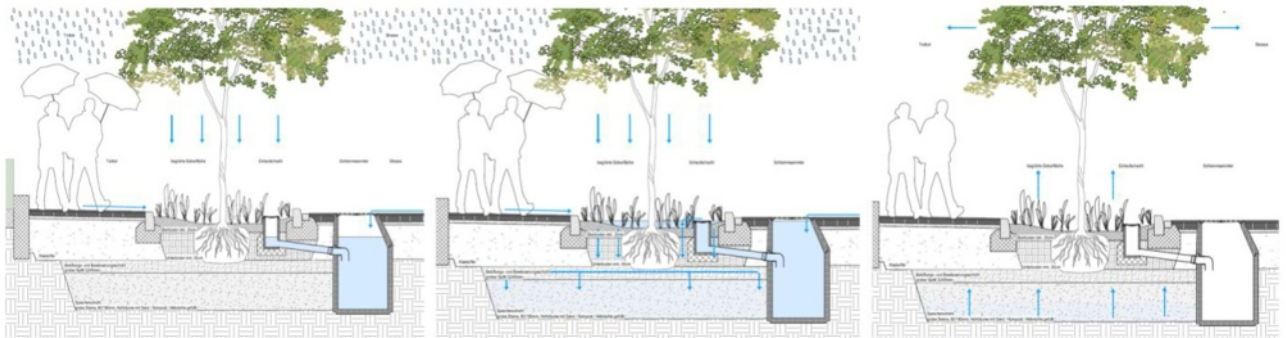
System Entwässerung Schwammstadt im Systemschnitt dargestellt (Bepflanzung Habsburgstrasse noch ausstehend)
